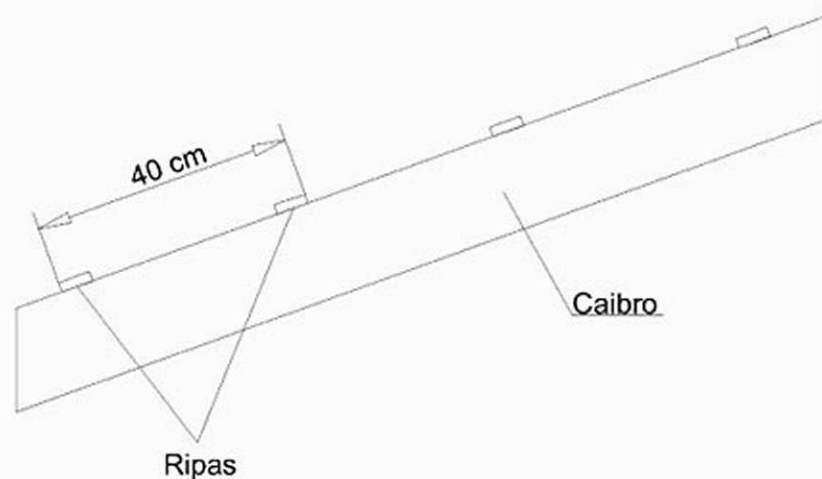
Exemplo do espaçamento utilizado para telhas francesas.
